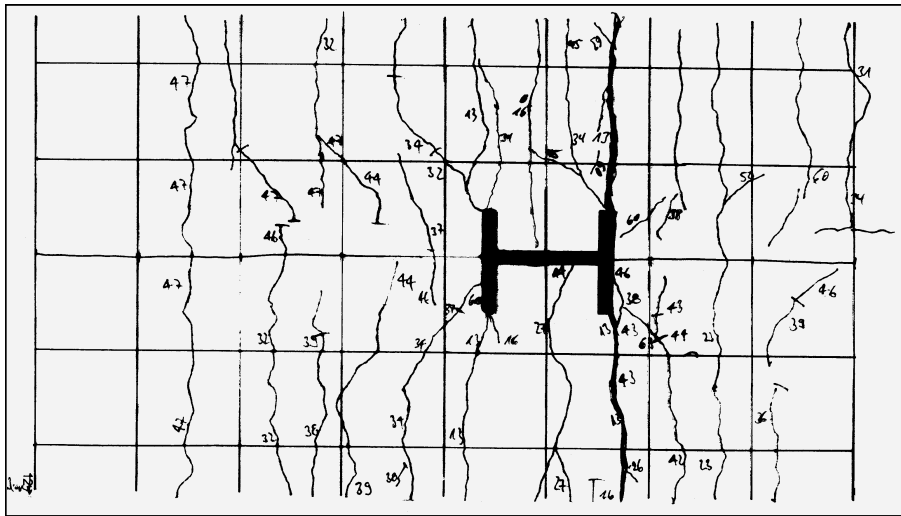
Rissbild des Betongurtes bei Versuch T5-1
